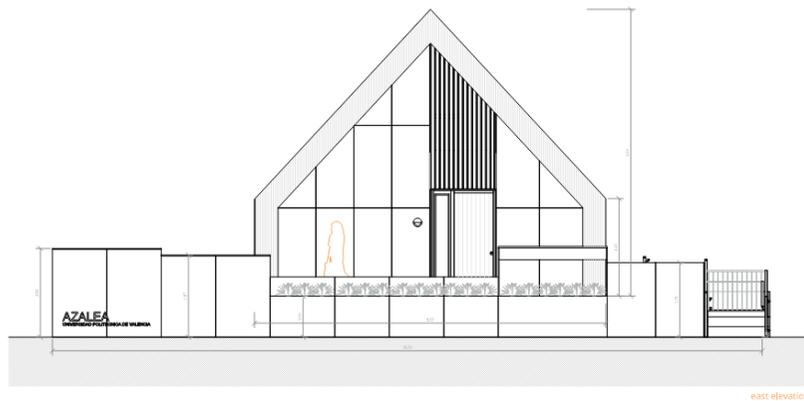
Alzado este del proyecto. Fuente: Azalea.
